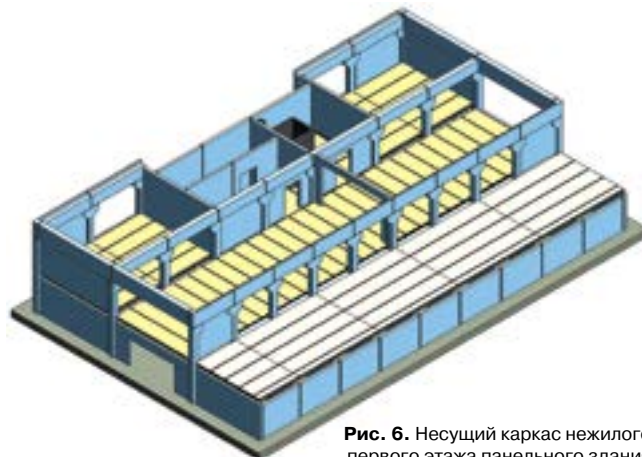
Несущий каркас нежилого первого этажа панельного здания
